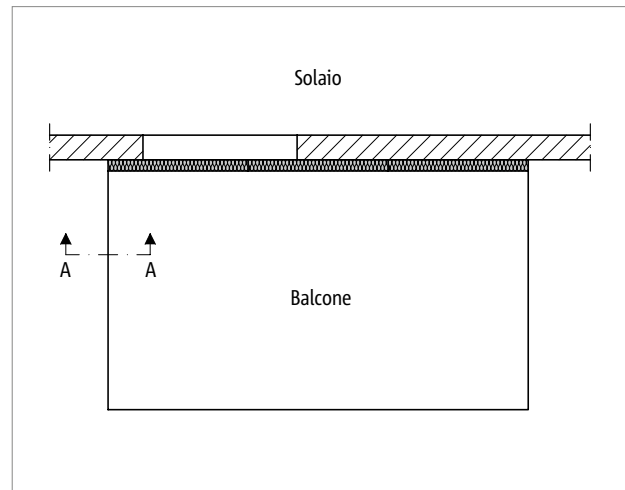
Schöck Isokorb® T tipo K: rappresentazione della posizione della sezione A-A
